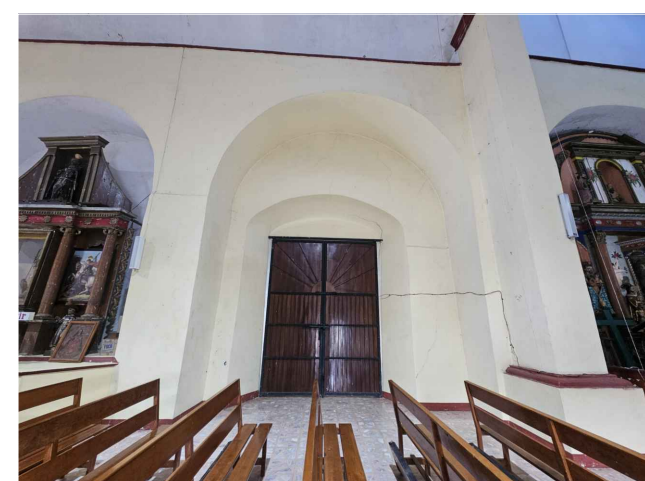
ACCESO LATERAL NORTE DESDE NAVE.
